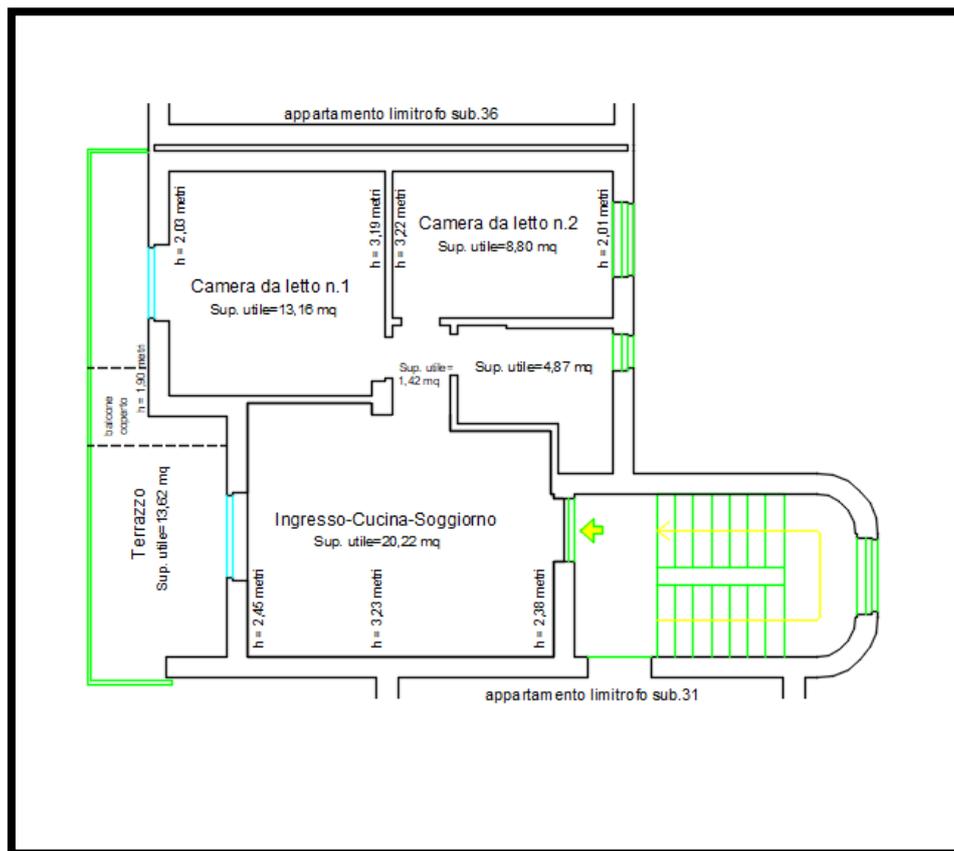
Rilievo appartamento part. 672 sub 21 – Piano terzo
